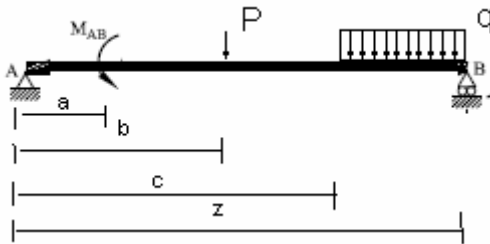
Gráfico para el caso de viga simplemente apoyada sometida a múltiples cargas
